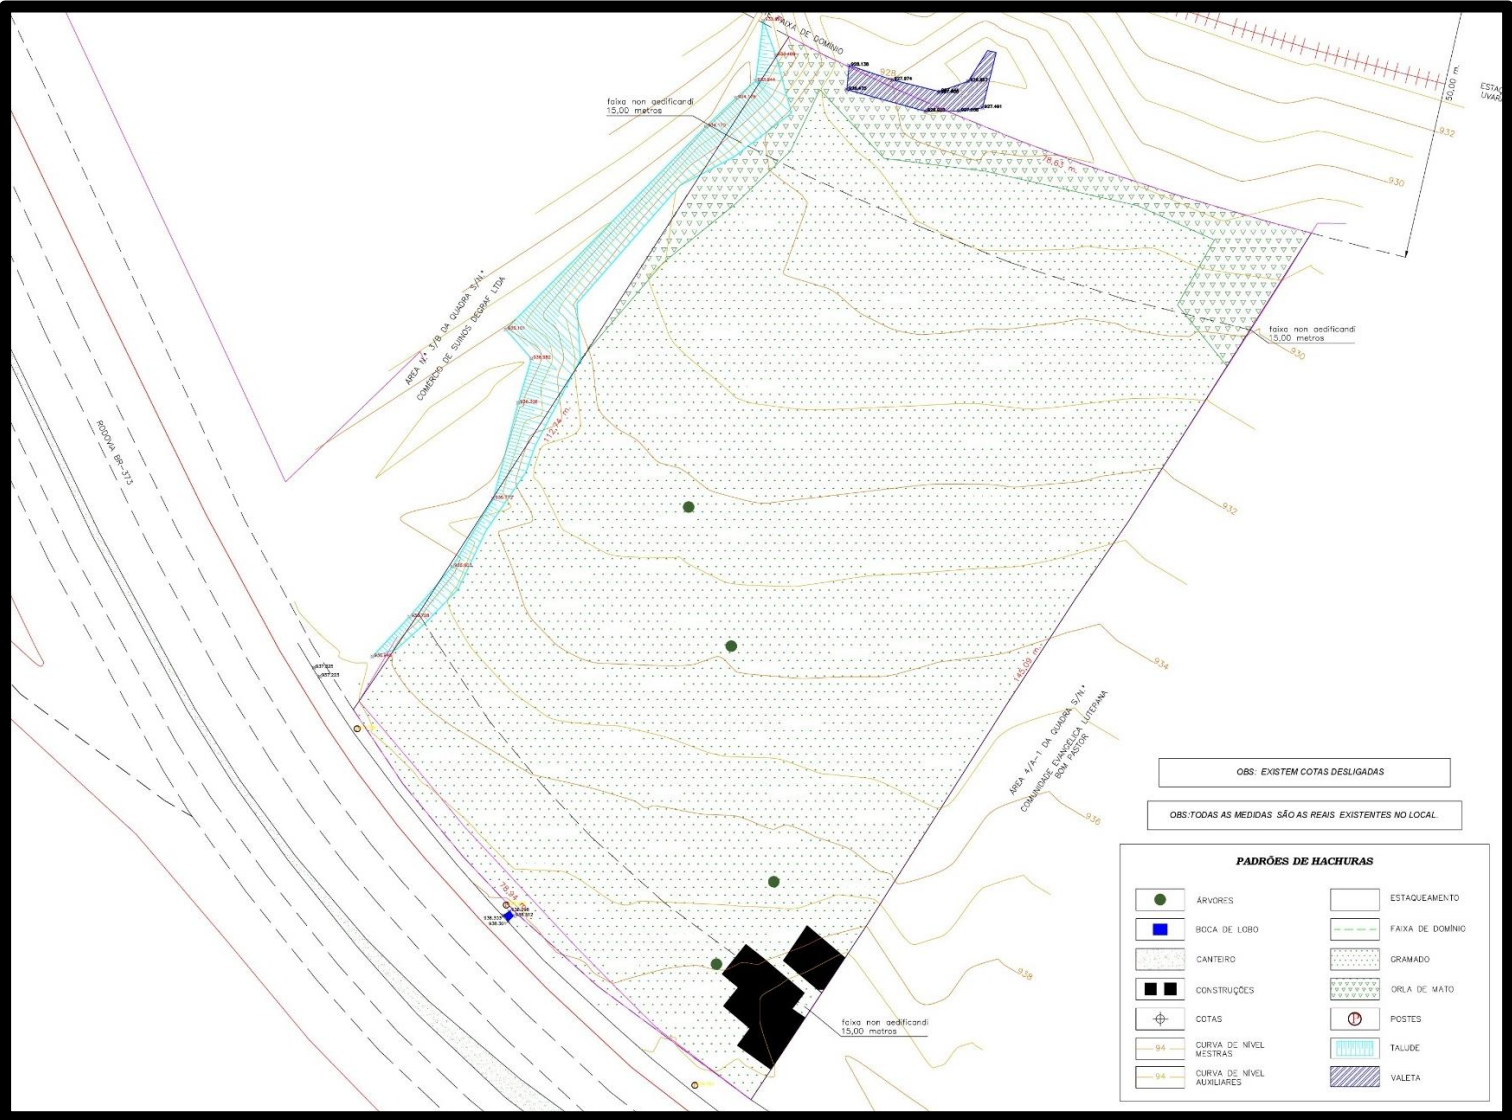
Vegetação existente na área de implantação do empreendimento. Fonte: Pilatti Topografia, 2017.
